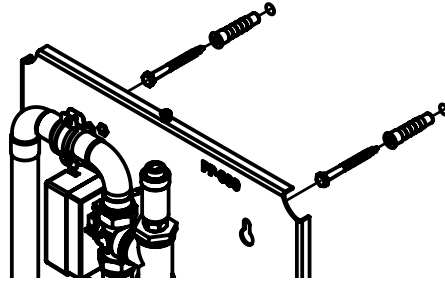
Befestigungsschrauben für die Gbox-Montage
